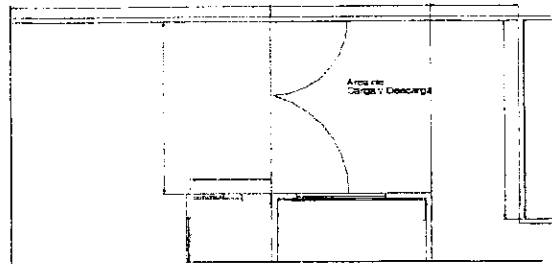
PLANO ÁREA CARGA Y DESCARGA
